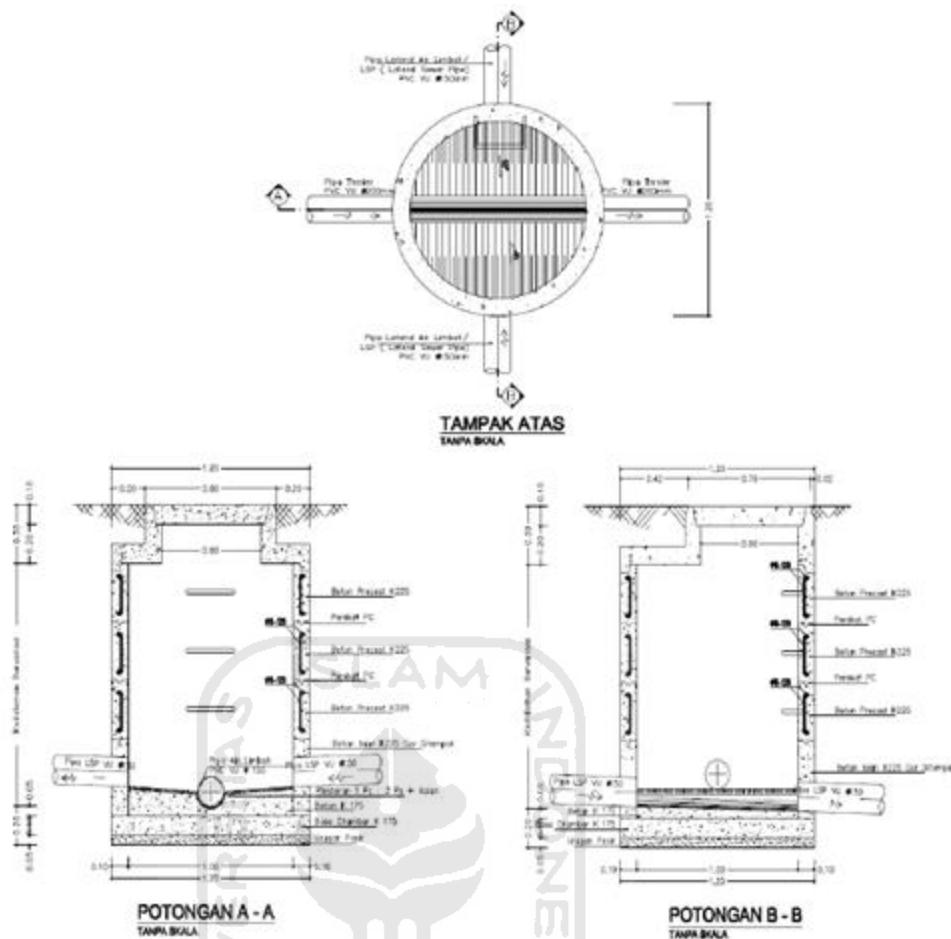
Tipikal Denah dan Potongan *House Inlet* (kiri) dan *House Inlet Box* (kanan)
